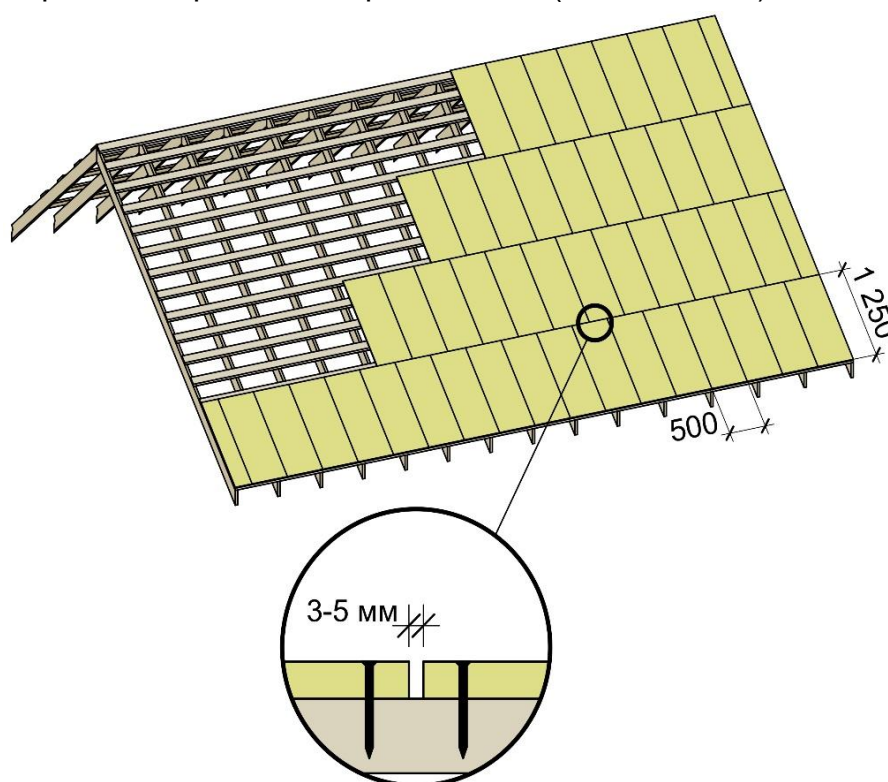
Укладка сплошного настила из плит ОСП-3 или фанеры ФСФ по обрешетке.
